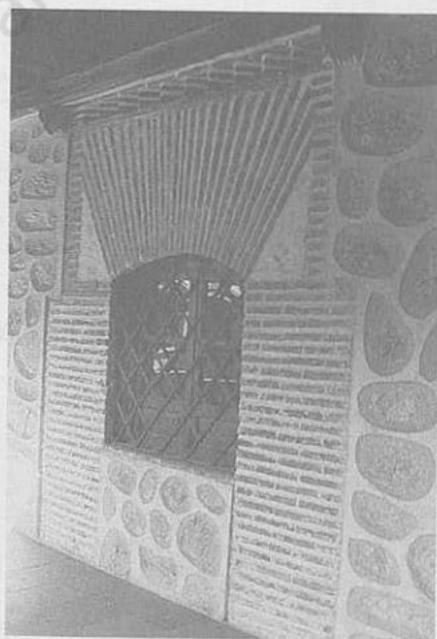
Claustro del Noviciado. Panda norte. Galería superior. Muro norte-lado sur. Vano nº 14.
